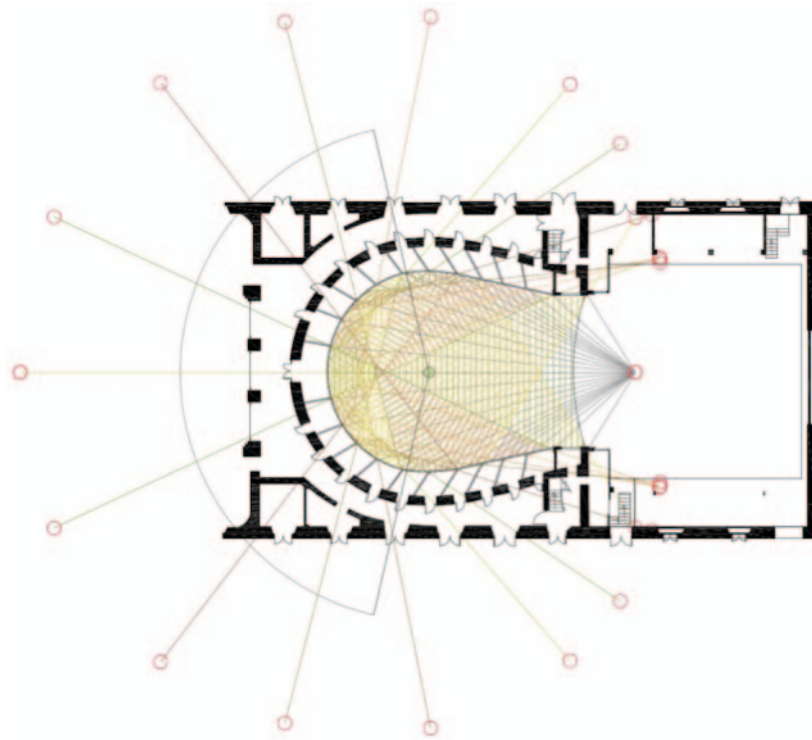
Planta Primera del Teatro Principal. Reflexiones de primer orden
